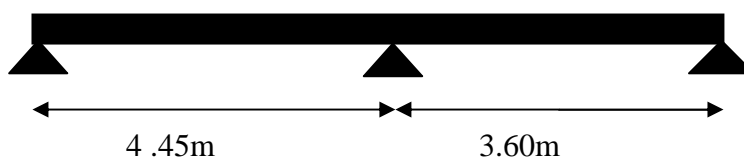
Schéma statique d'une poutrelle d'étage courant type 01
